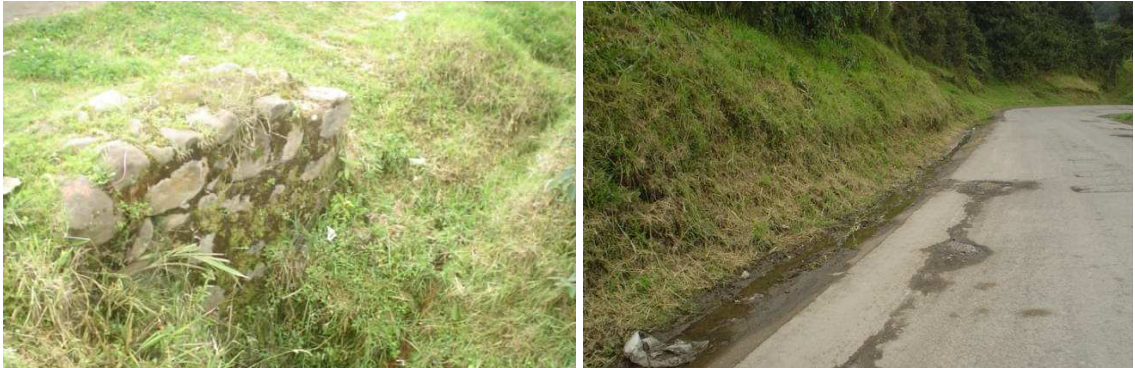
Trabajos complementarios, reubicación de tuberías de acueducto, alcantarillado, cajas
